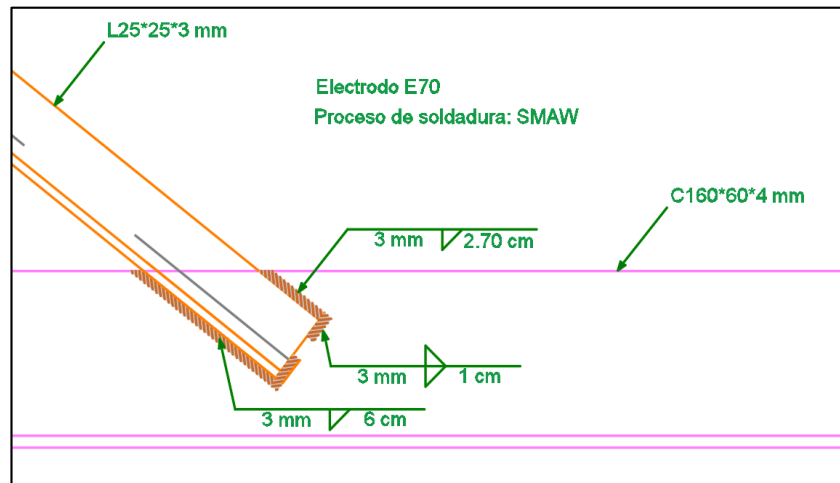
Detalle de Soldadura L25*25*3 mm.
